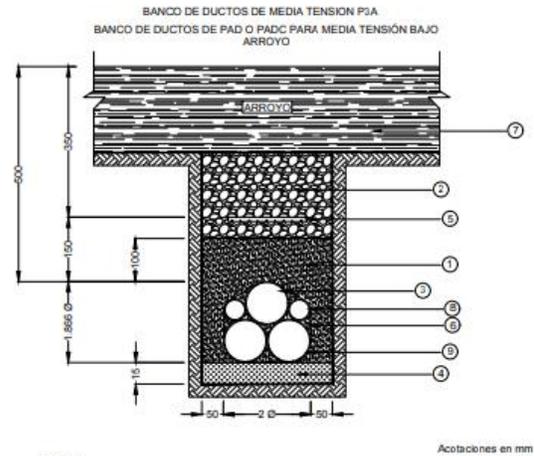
Detalle arquitectónico de la instalación eléctrica subterránea.
